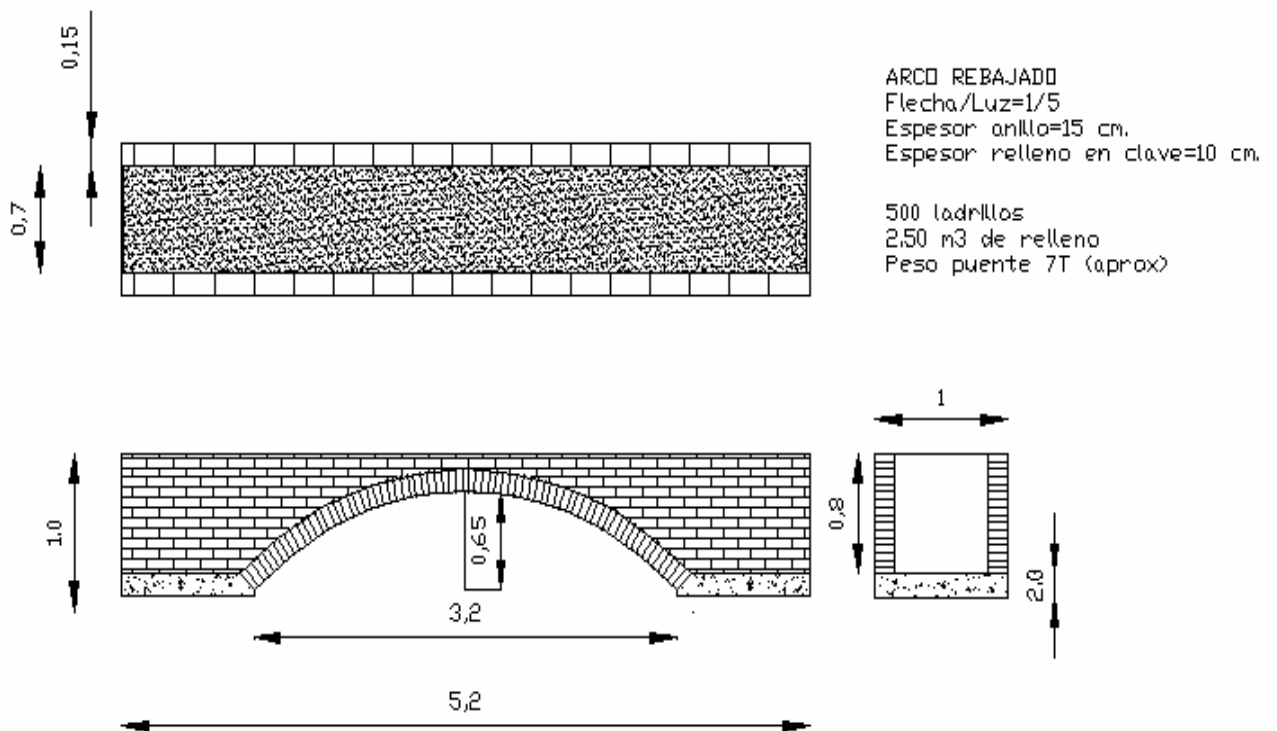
Geometría del puente rebajado ensayado por J. Serna y H. Gutiérrez. Imagen tomada de [5].
